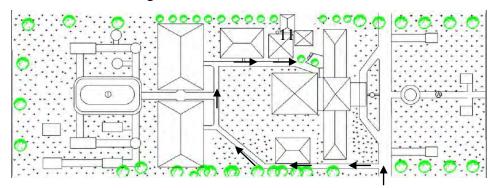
Alur denah eksisting area terpilih Sumber: Dokumen Pribadi(2016)
